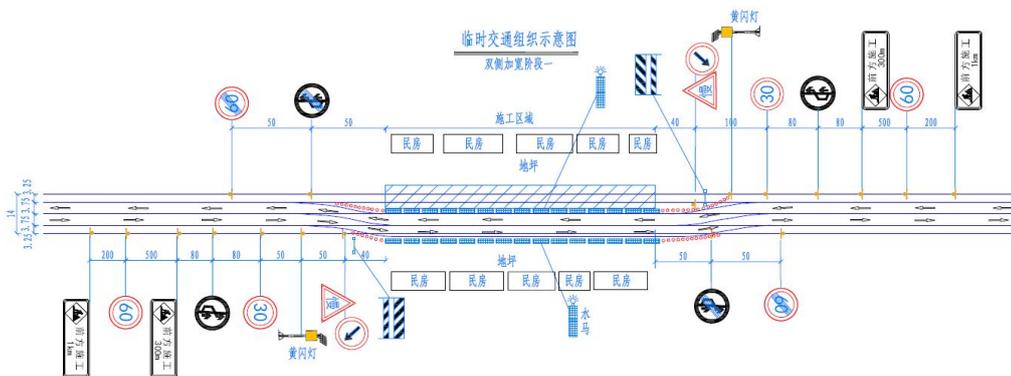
双侧拼宽临时交通组织平面图（施工阶段一）
